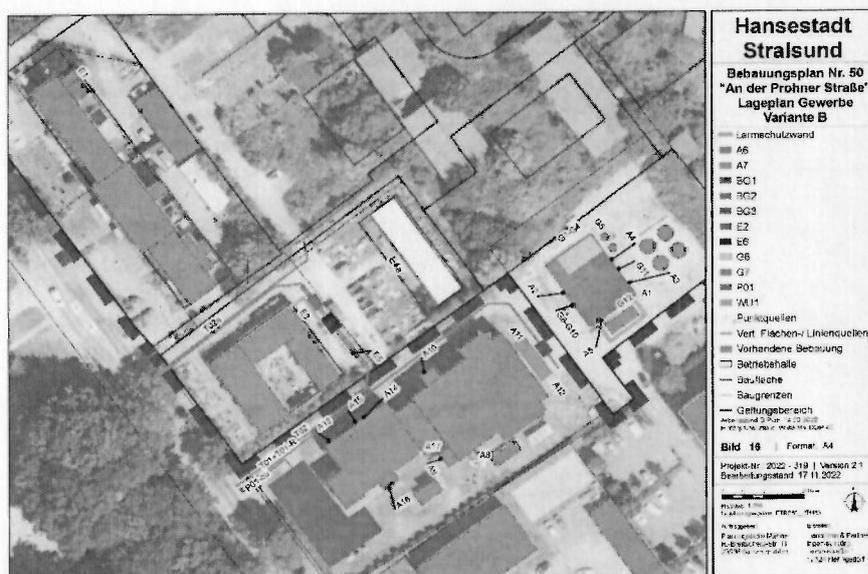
Lageplan mit Gewerbe mit Lärmschutz – Variante B (Auszug aus BILD 16 der Schalluntersuchung vom 18.11.2022)
